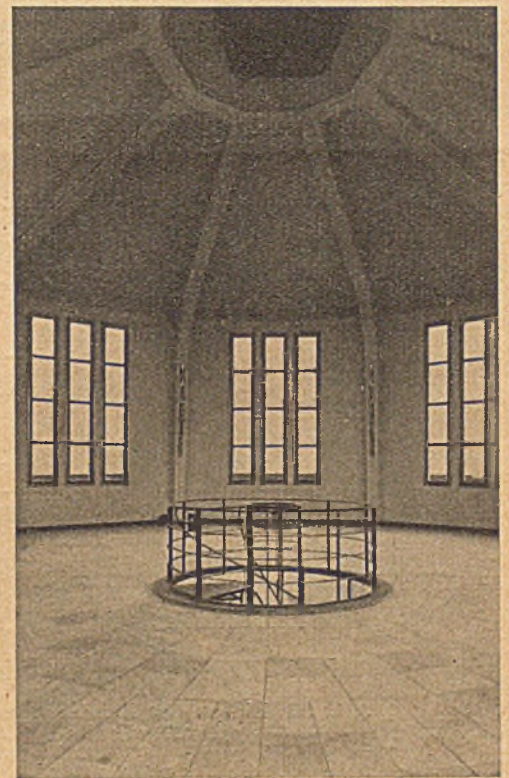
Raum über dem Behälter mit Dachkonstruktion.
